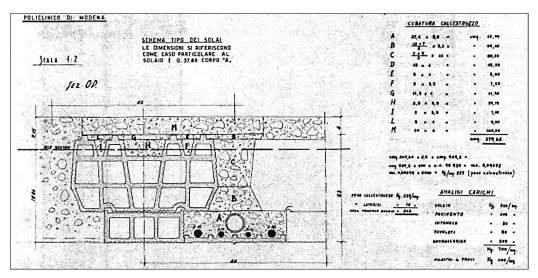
Stralcio della tavola di progetto originale TAV 59 CA.
